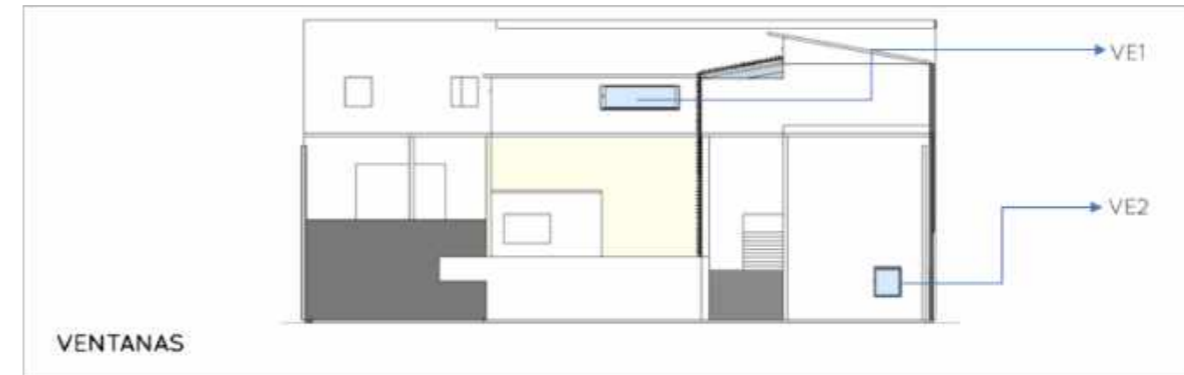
Nomenclatura en ventanas de fachada este. Fuente: Elaboración propia
